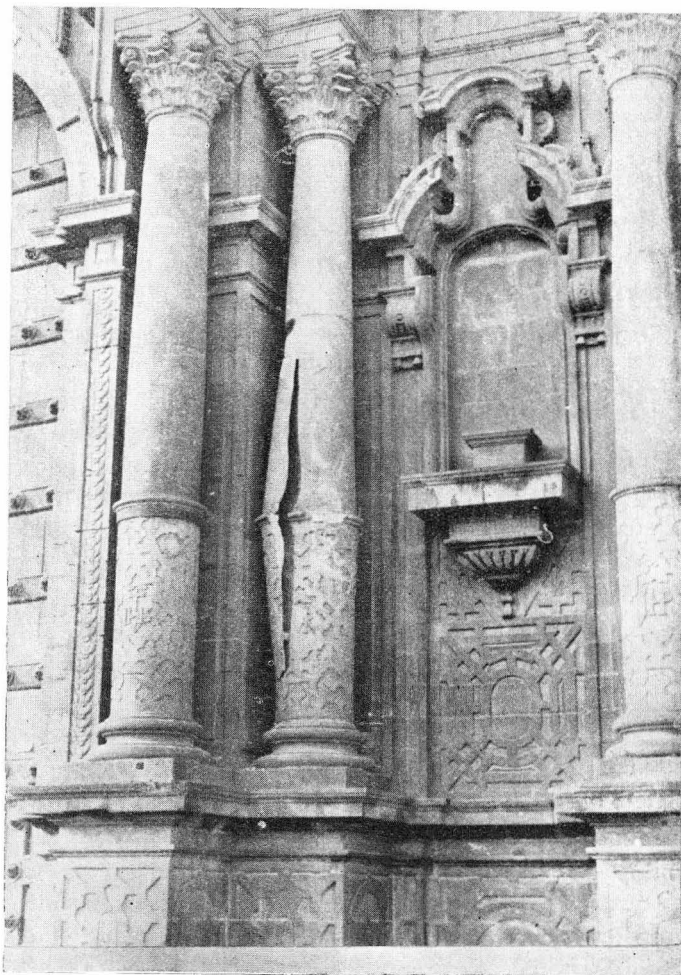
Iglesia de La Merced; una de las columnas de piedra de la fachada se rajó longitudinalmente durante el terremoto.
